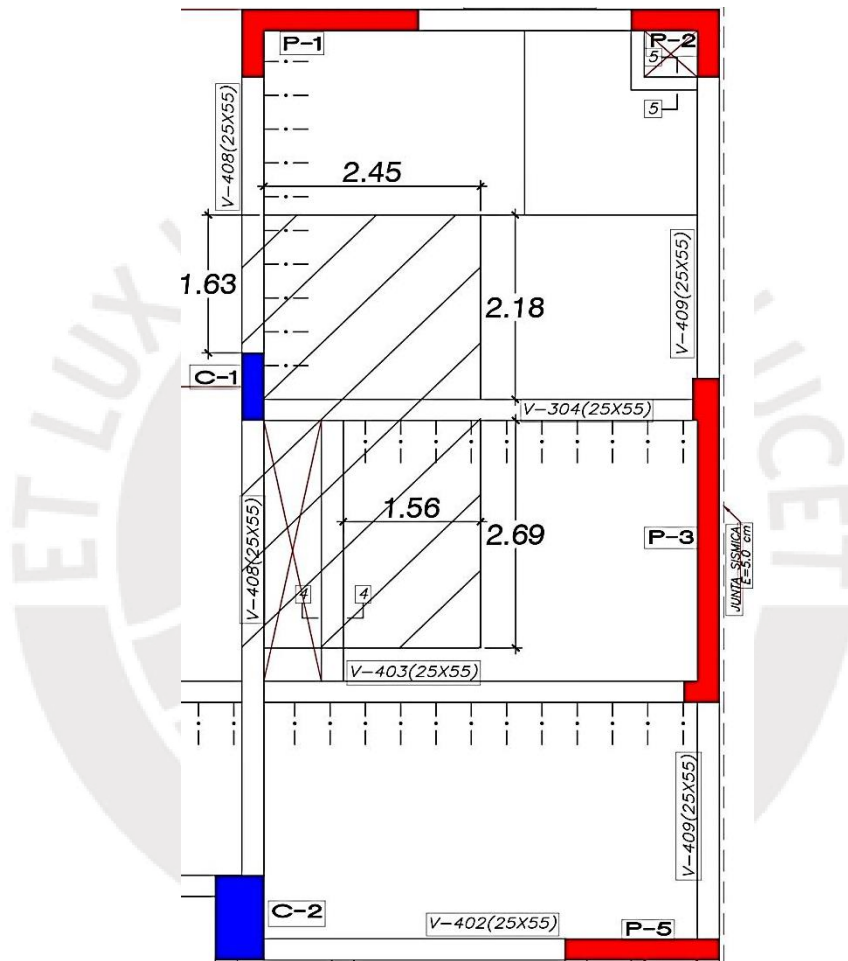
Planta de área tributaria de la columna C-1 en la azotea
